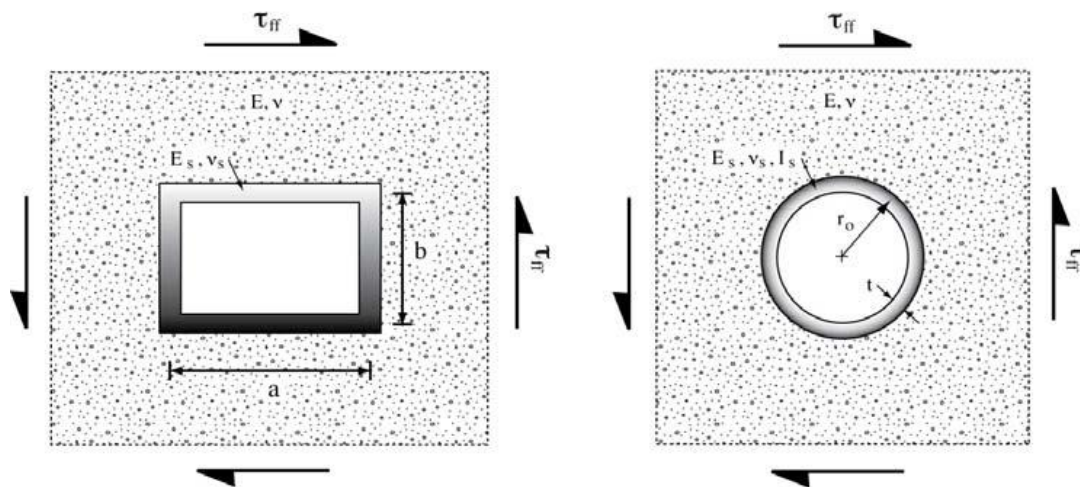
Estructuras enterradas profundas: (a) Estructura rectangular; (b) Estructura circular.
